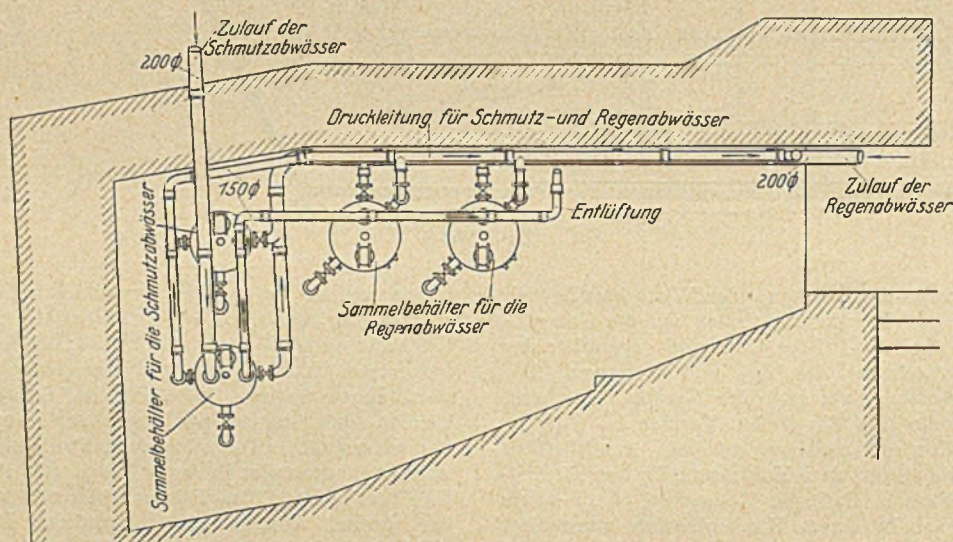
Selbsttätige Schmutzwasserhebeanlage mittels Preßluft. Grundriß.
